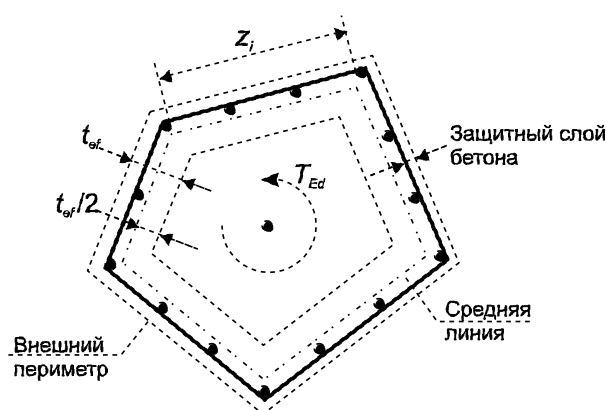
Обозначения и определения при расчете на кручение
